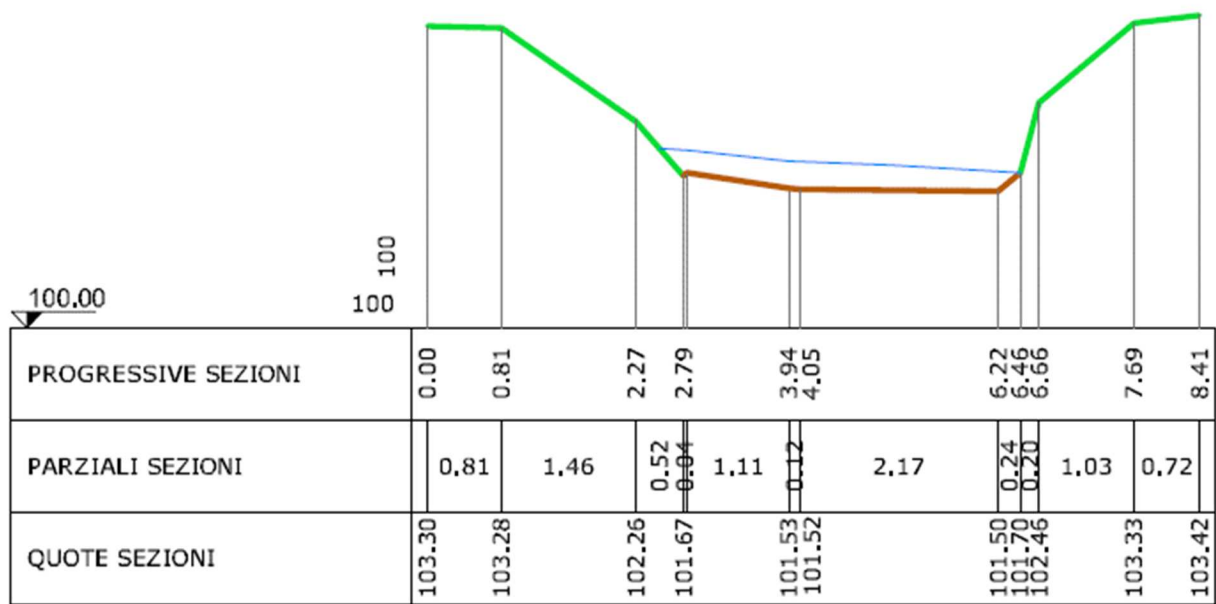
Sezione trasversale T1145 – 655 (sezione in corrispondenza della nuova passerella in oggetto)
